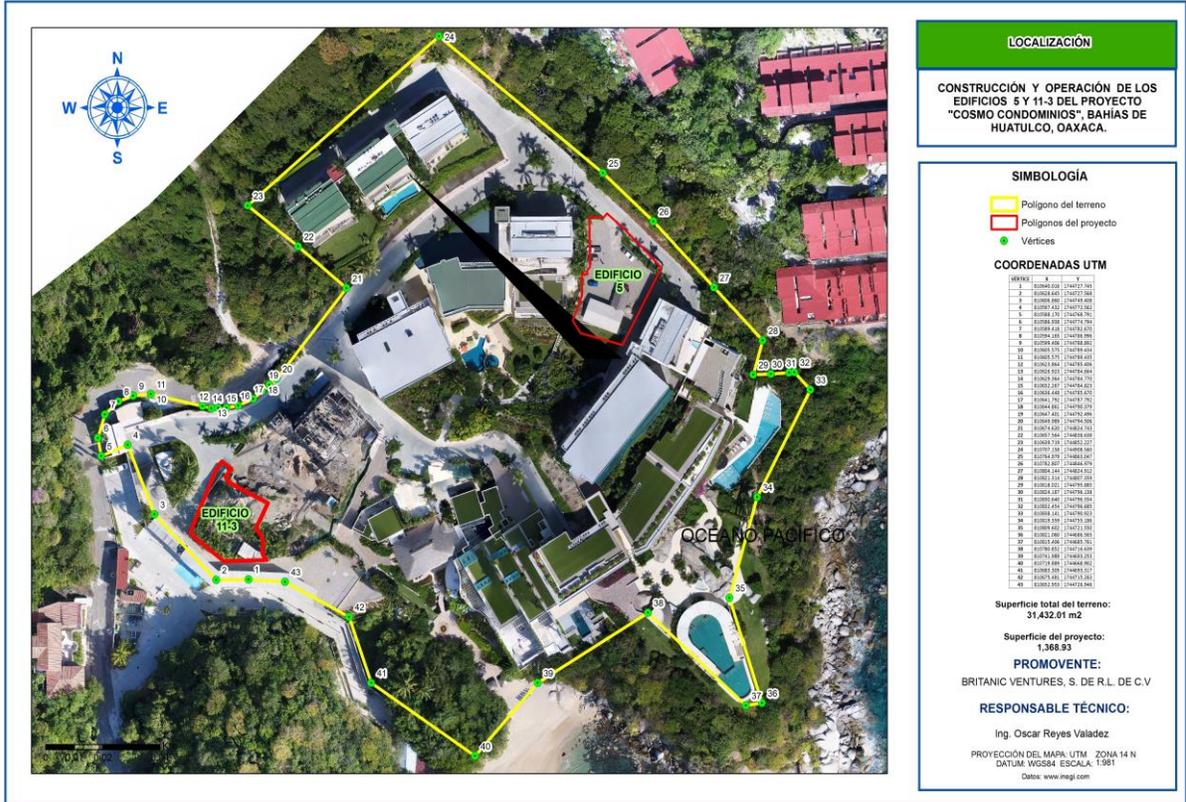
Ortofoto de ubicación del polígono general del terreno y áreas propuestas a construcción.
